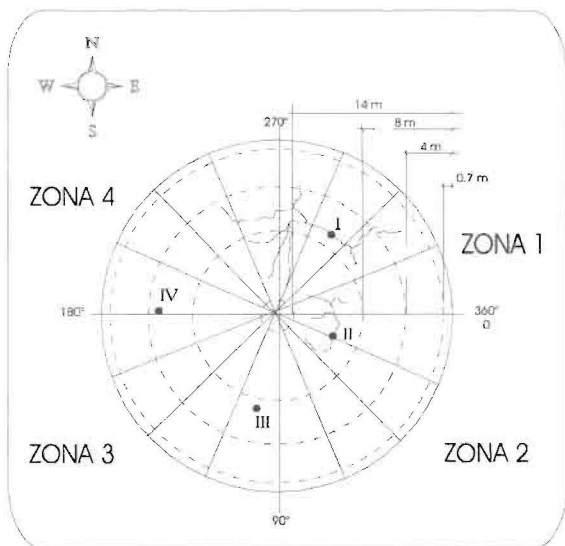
Plano de grietas de la cúpula y zonas usadas para los ensayos.
